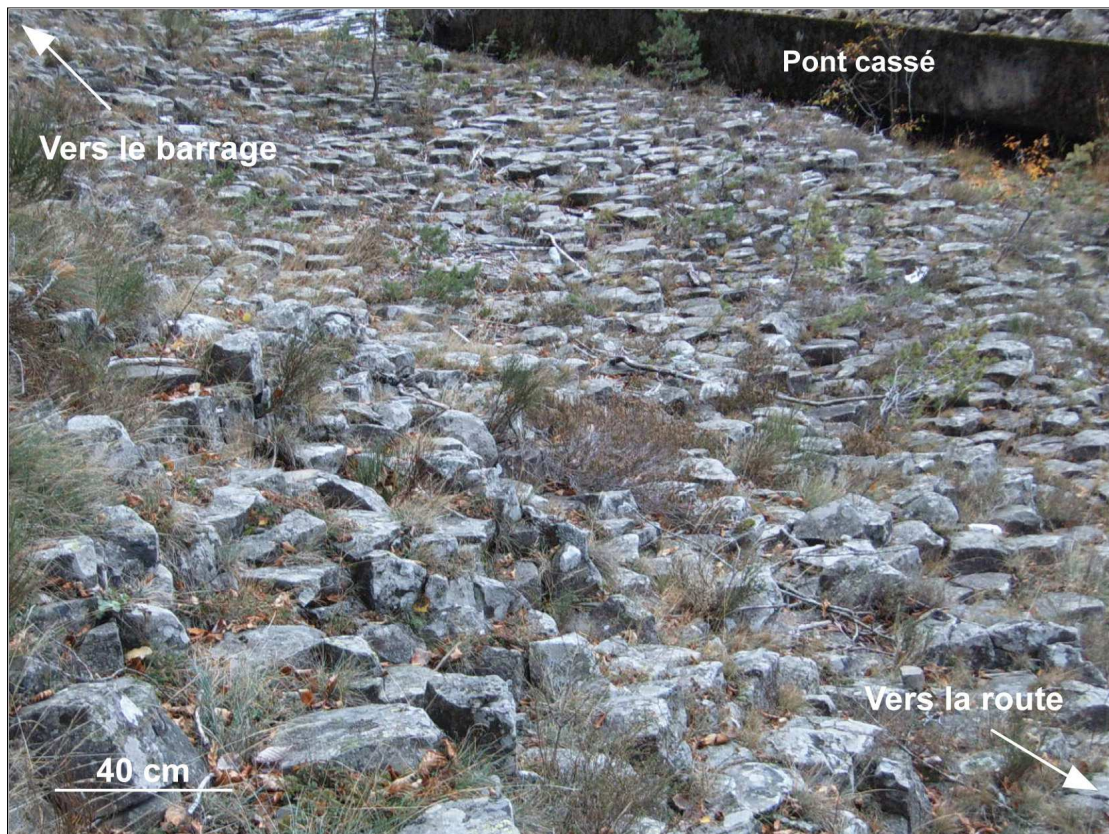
« Chaussée des Géants », section des prismes issus de la colonnade, La Palisse barrage.
